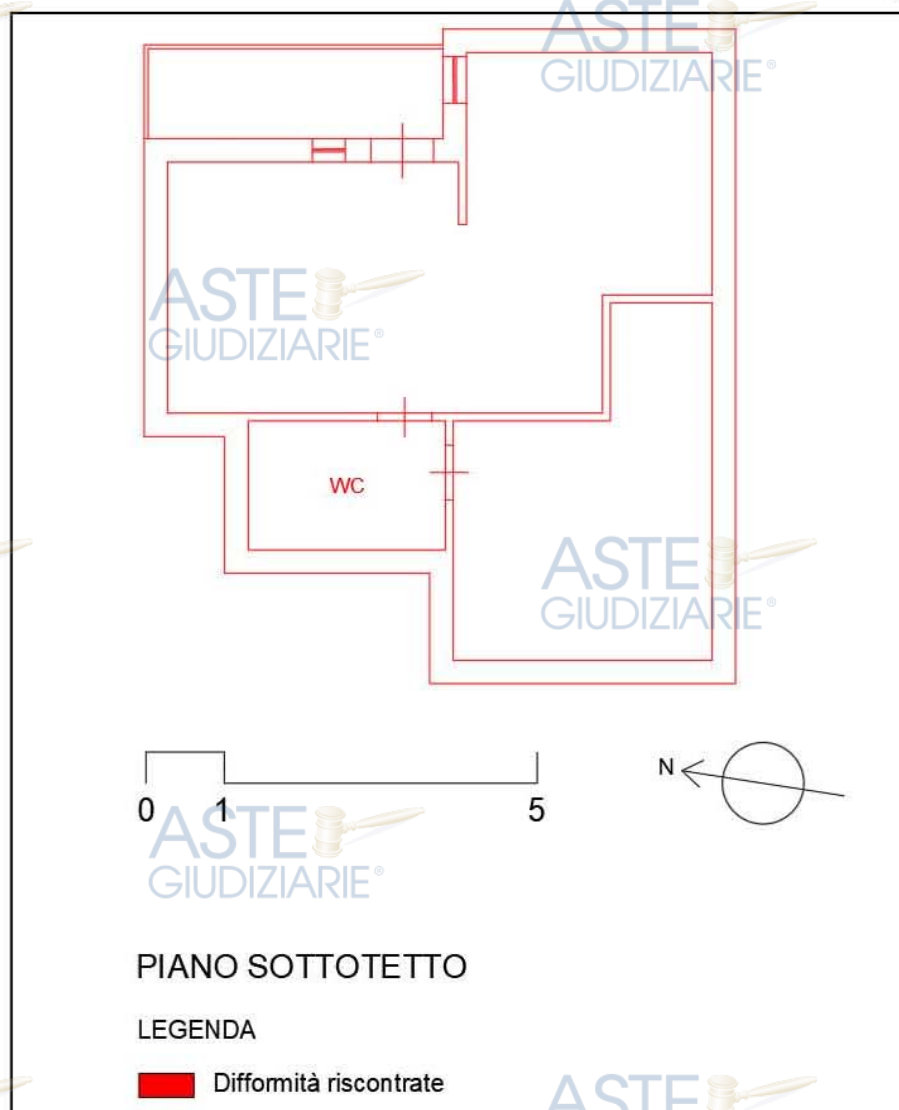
Difformità riscontrate rispetto la planimetria associata alla Concessione in Variante n. 67/2008: piano sottotetto
